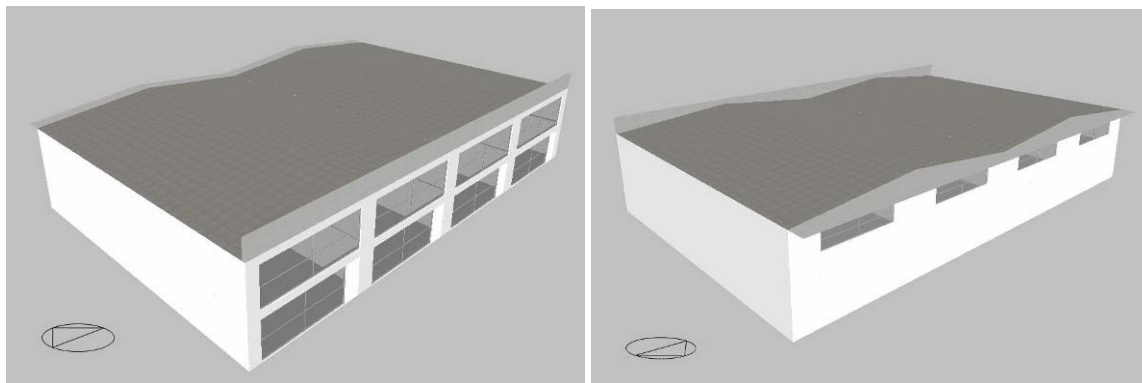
Fachadas frontal (Sul) e lateral (Oeste), e fachadas lateral (Leste) e posterior (Norte),
